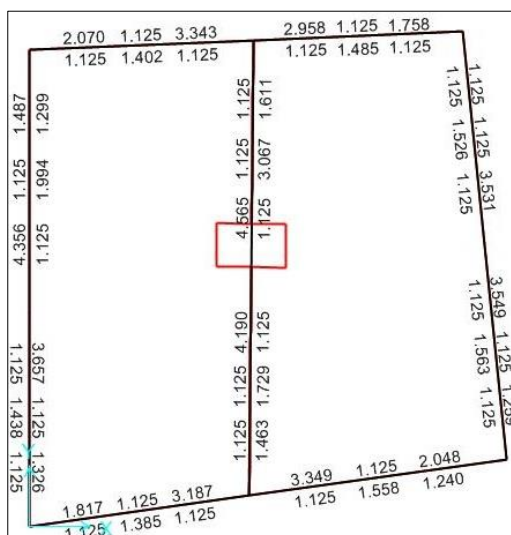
Armadura longitudinal nas vigas (piso de esteira)
